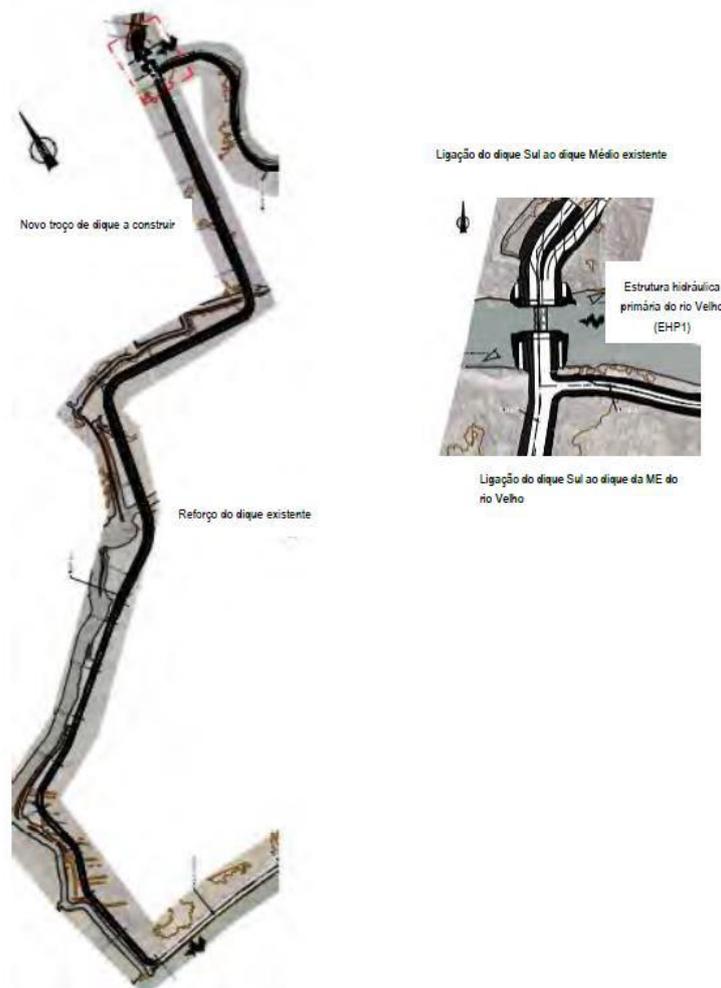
Planta geral do dique Sul e pormenor da estrutura hidráulica primária do rio Velho (EHP1)
